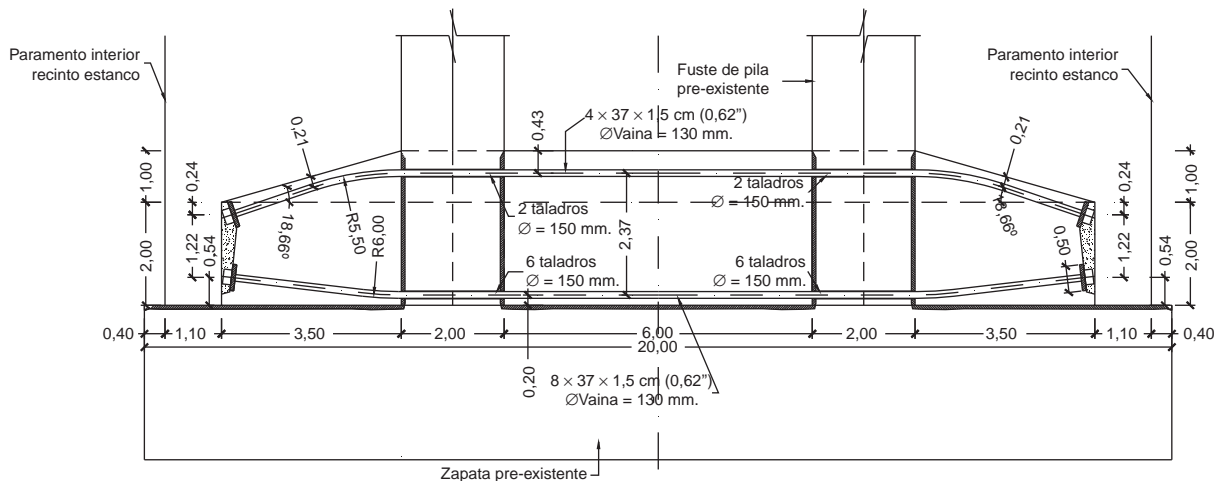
Alzado longitudinal del pretensado del recerido en pilas 1 y 4.
